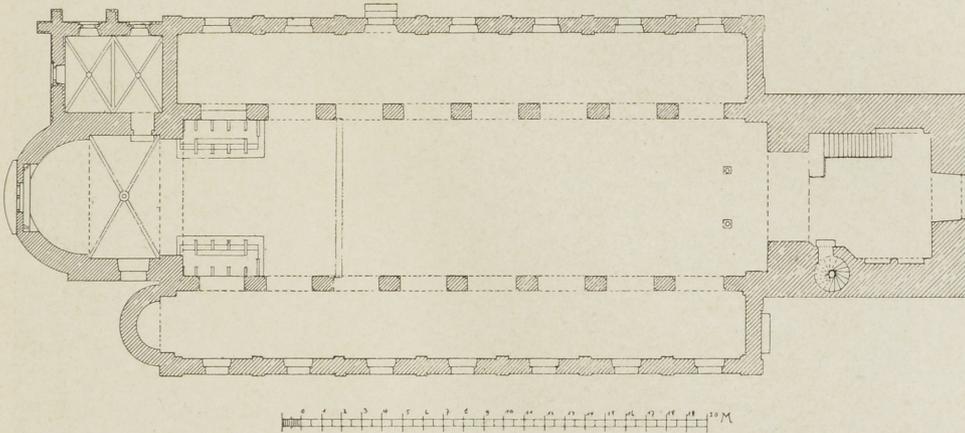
Wassenberg, Grundriss der kath. Pfarrkirche.
